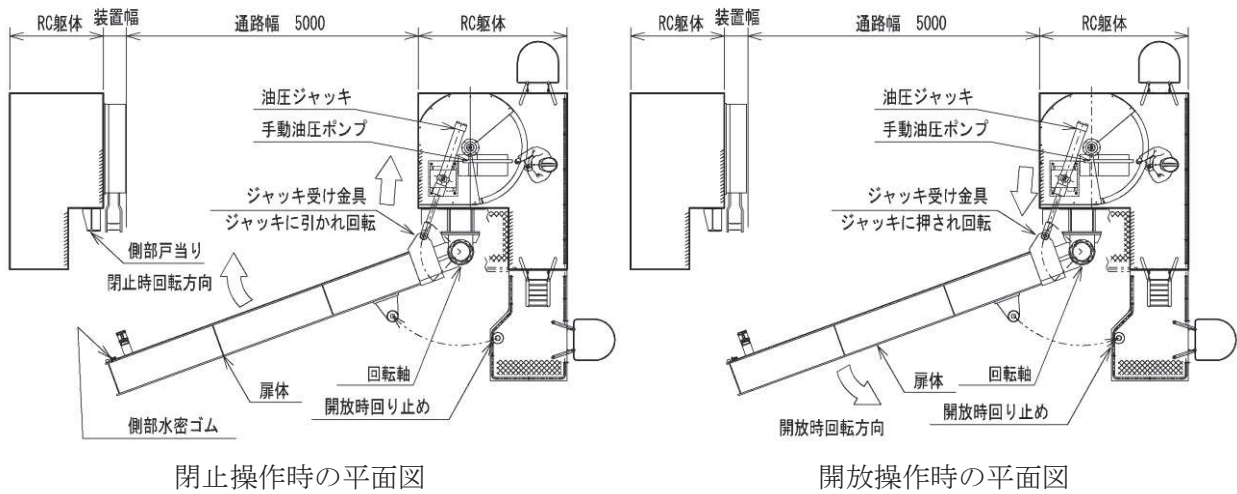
開閉装置（油圧ポンプ、油圧ジャッキ）の動作概要及び操作時の平面図
